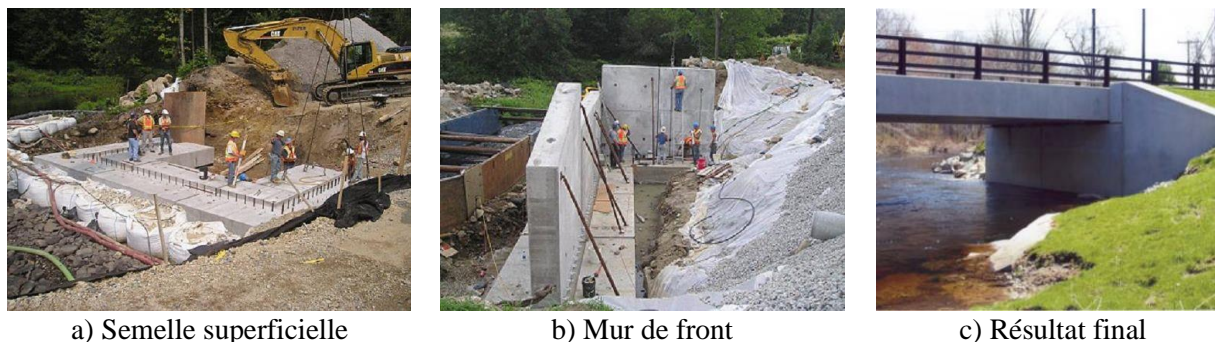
Construction d'une culée préfabriquée - Pont d'Epping (ABC-UTC, 2021; Stamnas & Whittemore, 2005)
